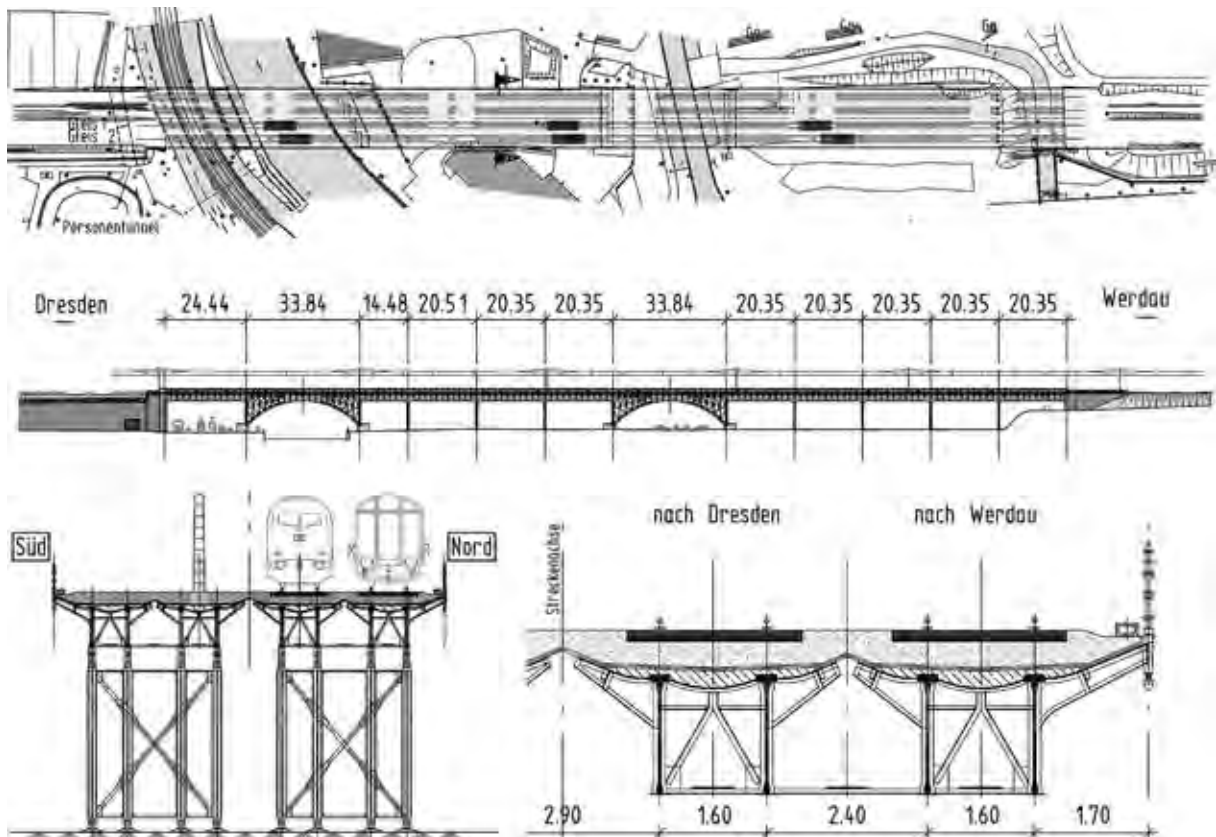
Ansicht, Grundriss und Querschnitte des Chemnitztalviaduktes
